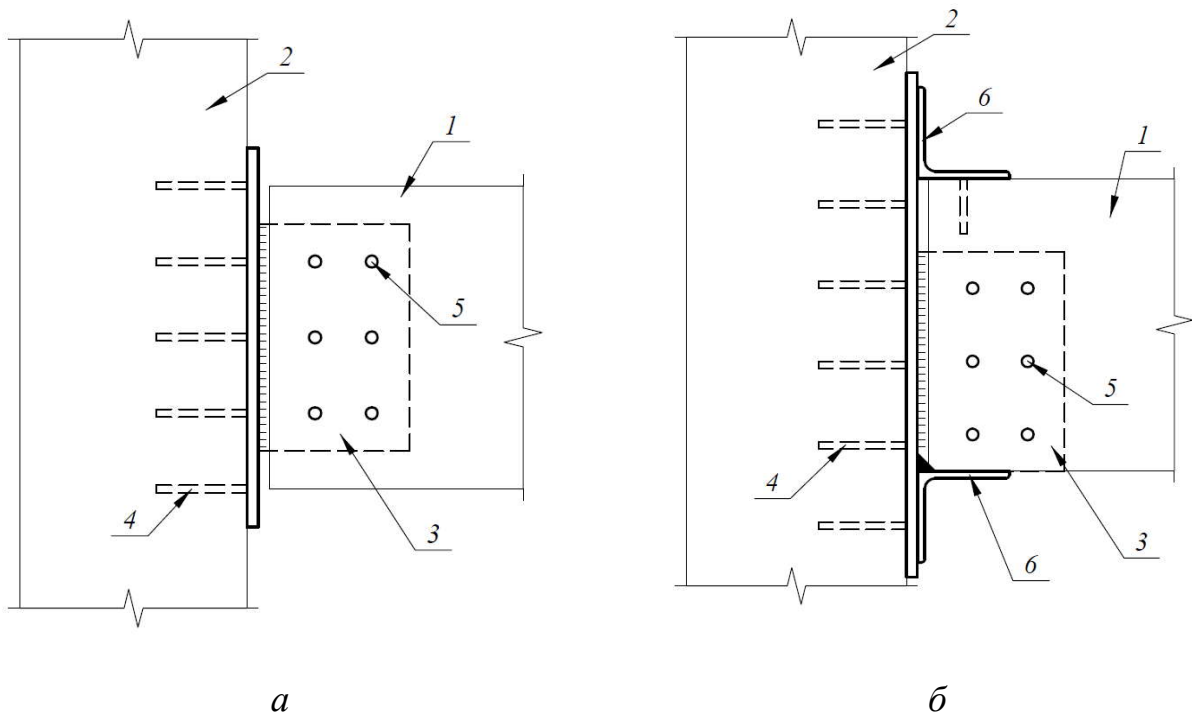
Загальний вигляд конструкції вузлів сполучення клеєної дерев'яної балки та колони: а) шарнірний; б) жорсткий; 1 – балка; 2 – колона; 3 - Т-подібний зварний елемент; 4, 5 –шпильки; 6 – кутники
